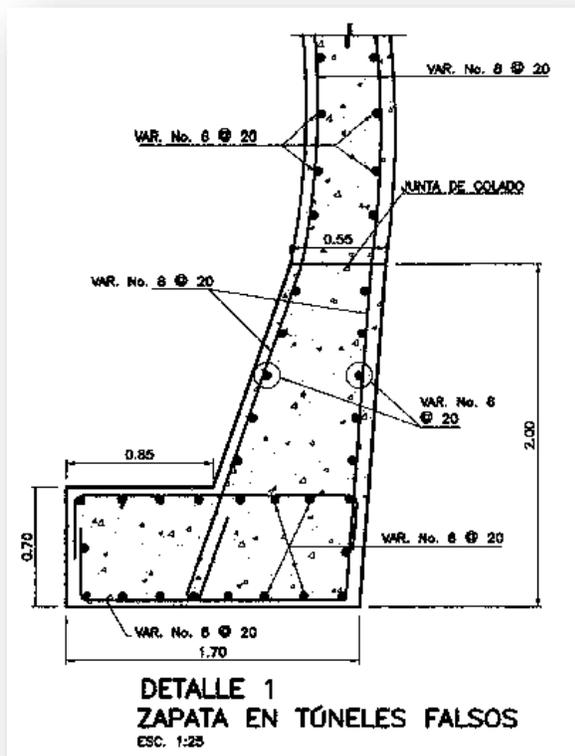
Zapata en túneles falsos. Fuente (Proyecto ejecutivo).
